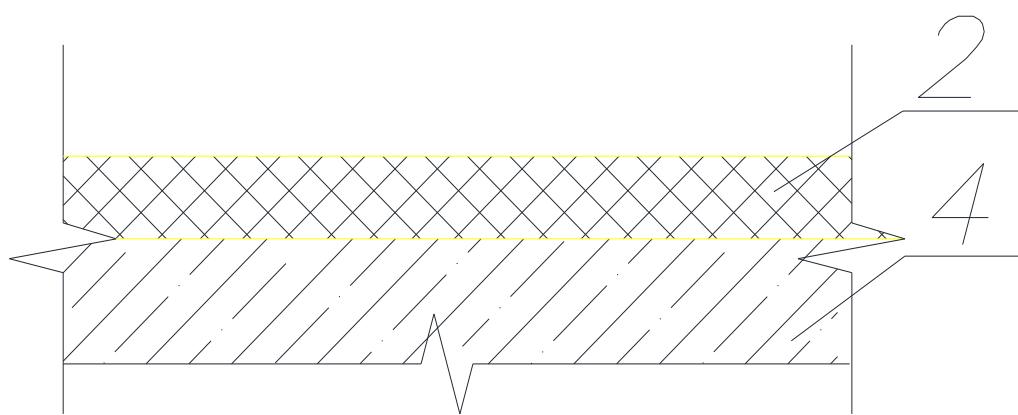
Конструкция покрытия над техническим этажом
